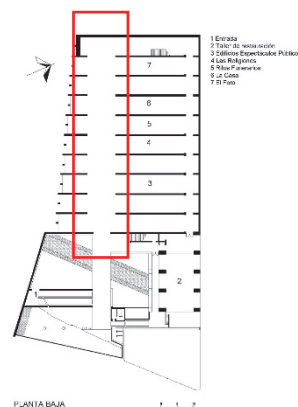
Planta baja, nave principal (Dibujo por el autor).
